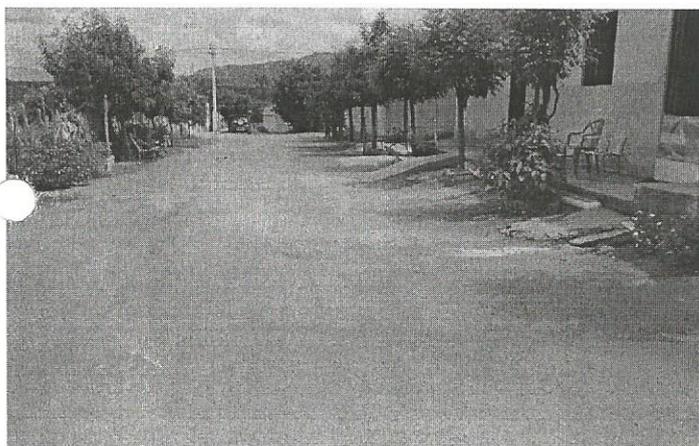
RUA S.D.O. 03 (TRECHO 01)
